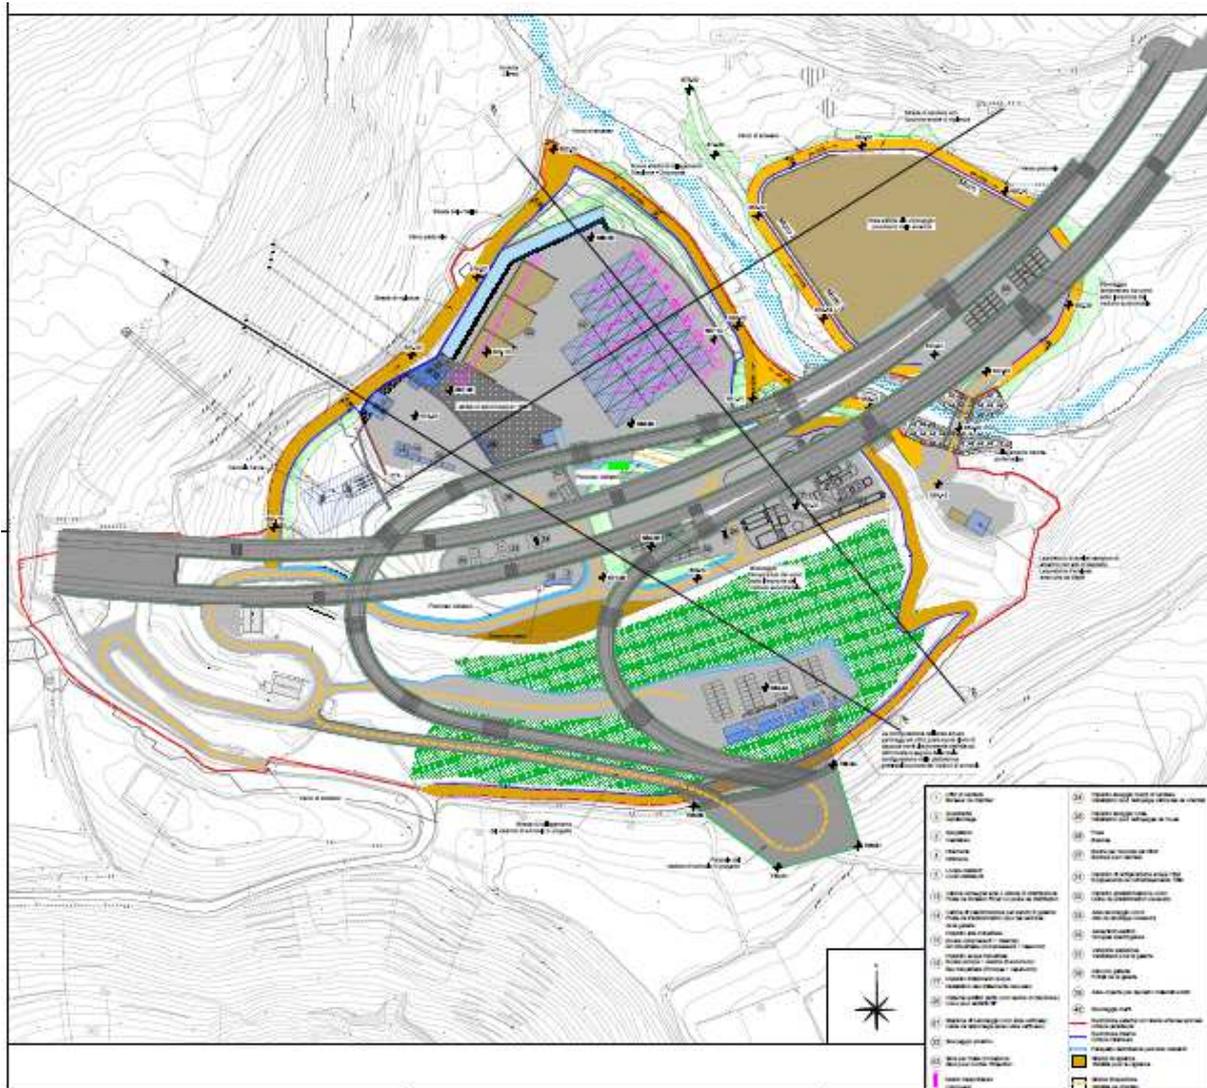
Imbocco Gallerie di Maddalena – Planimetria aree di cantiere
